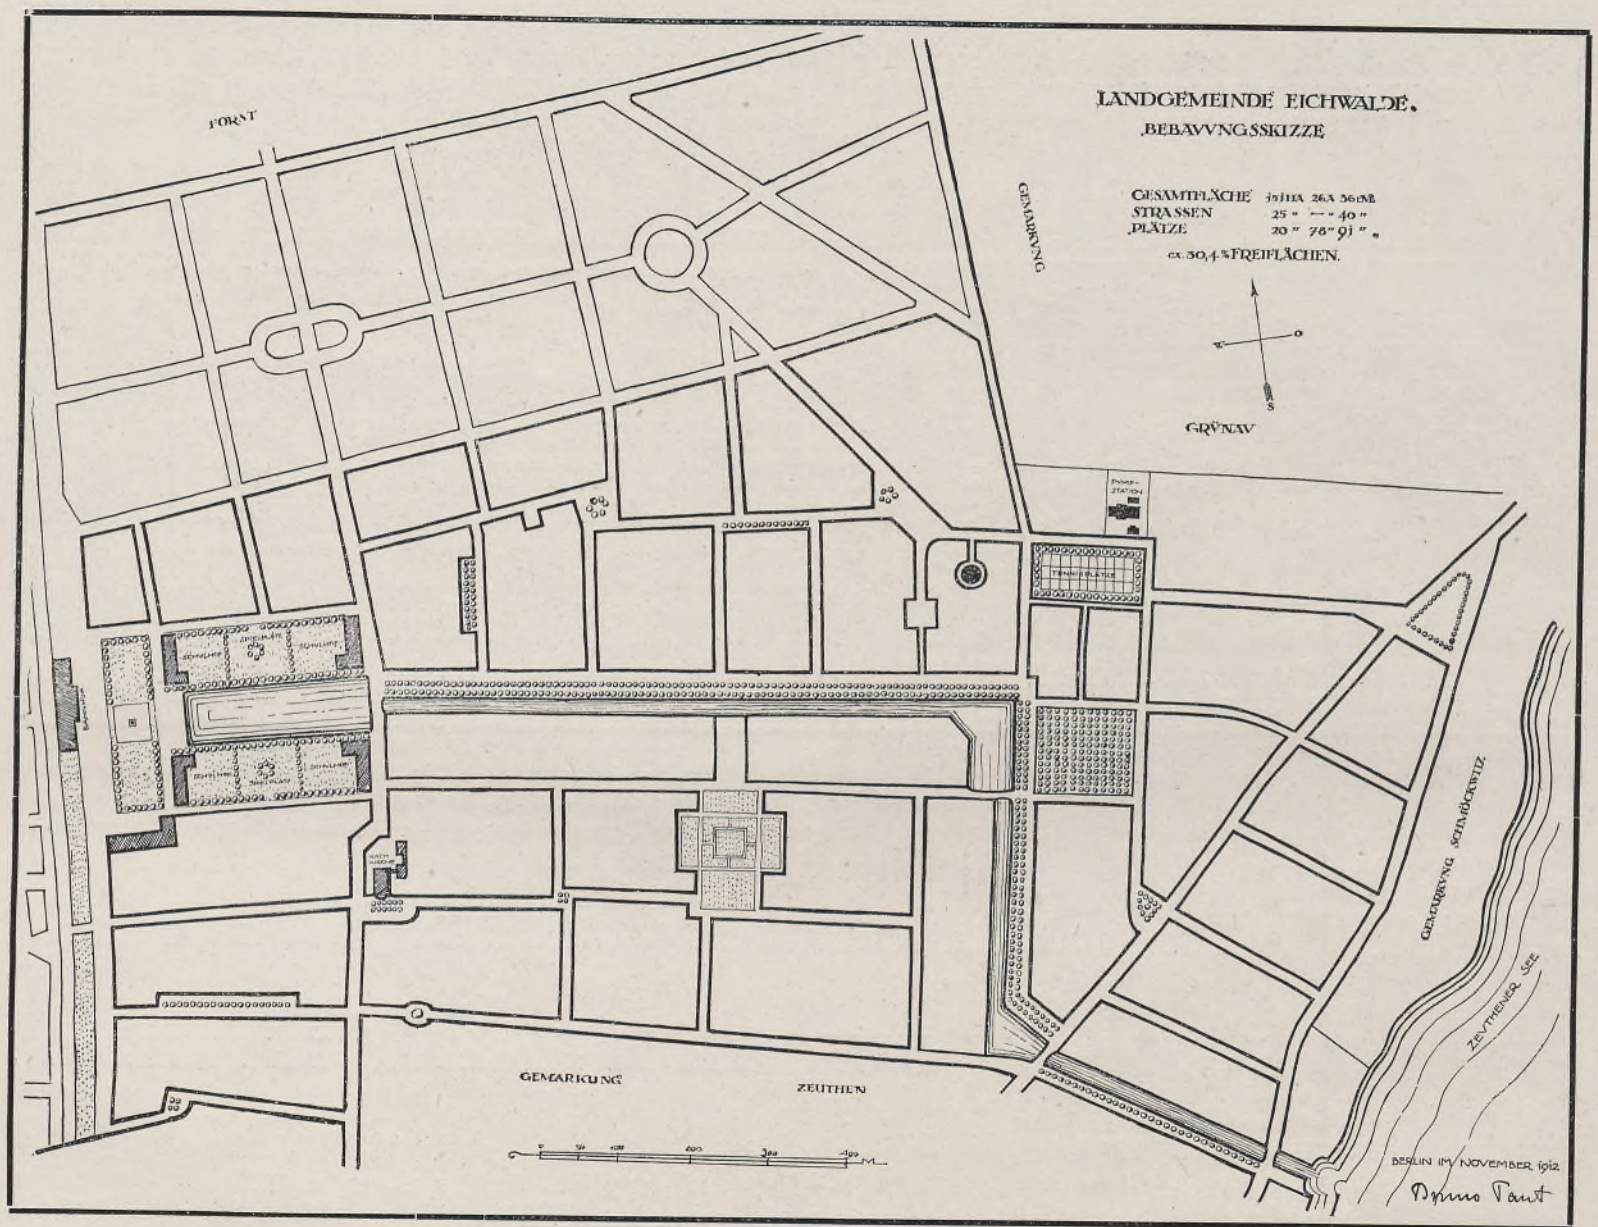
Bebauungsplan für Eichwalde bei Berlin. Variante mit Kanalanlage von Bruno Taut, Architekt in Berlin.
